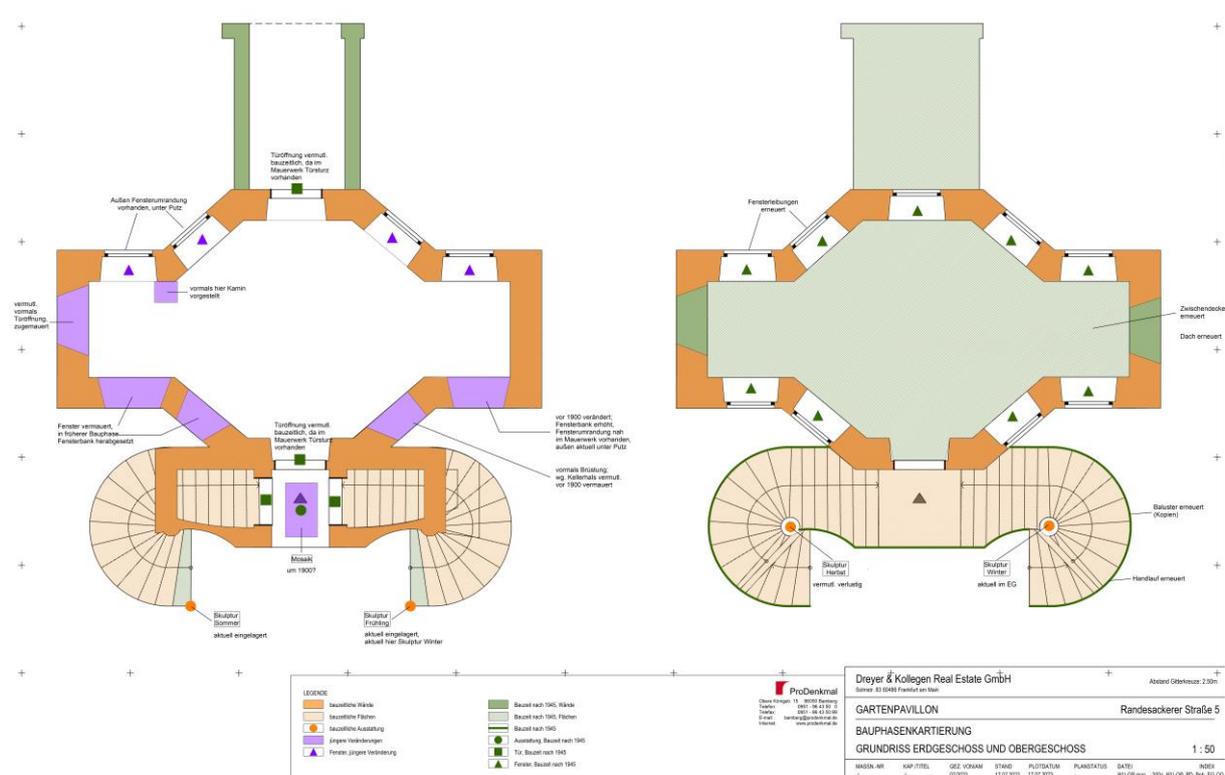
Bauphasenplan mit Ausweisung denkmalrelevanter Ausstattungselemente (s. auch Anlage 7.2).
